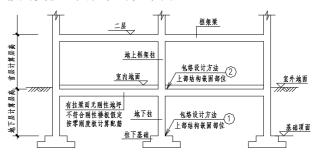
首层地面设置拉梁而没有钢筋混凝土刚性地坪板
